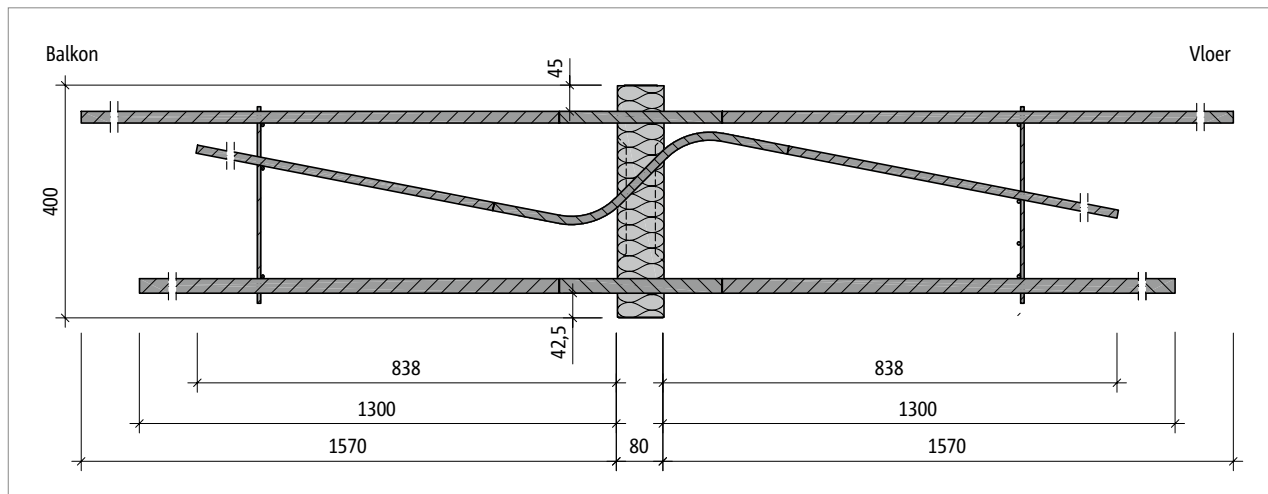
Schöck Isokorf® T type B: Brandwerende platen rondom
